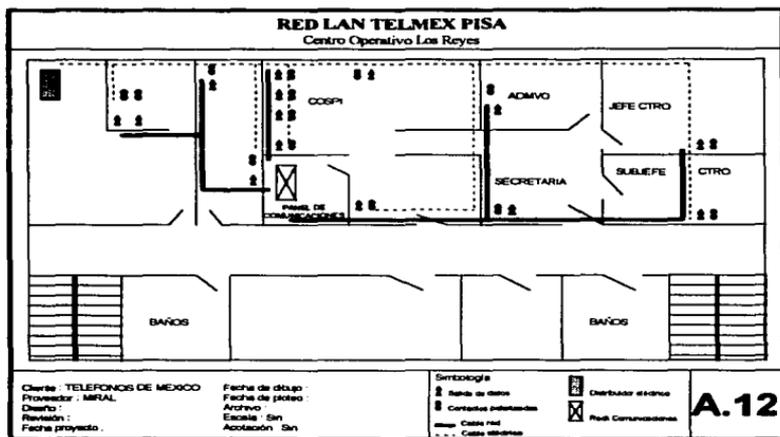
Planos de distribución de cableado eléctrico y de red.
